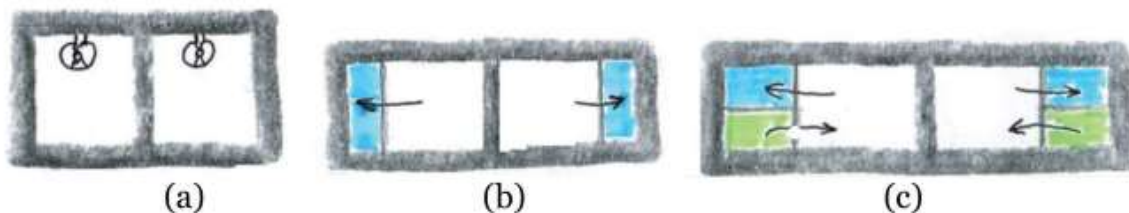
(a) Ventilation longitudinale, (b) ventilation semi transversale, (c) ventilation transversale
